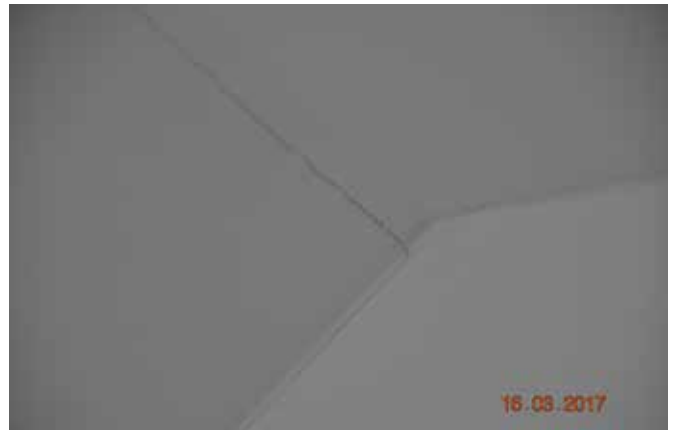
Riss zur Giebelwand und zur Dachdecke (Stahlbeton)
